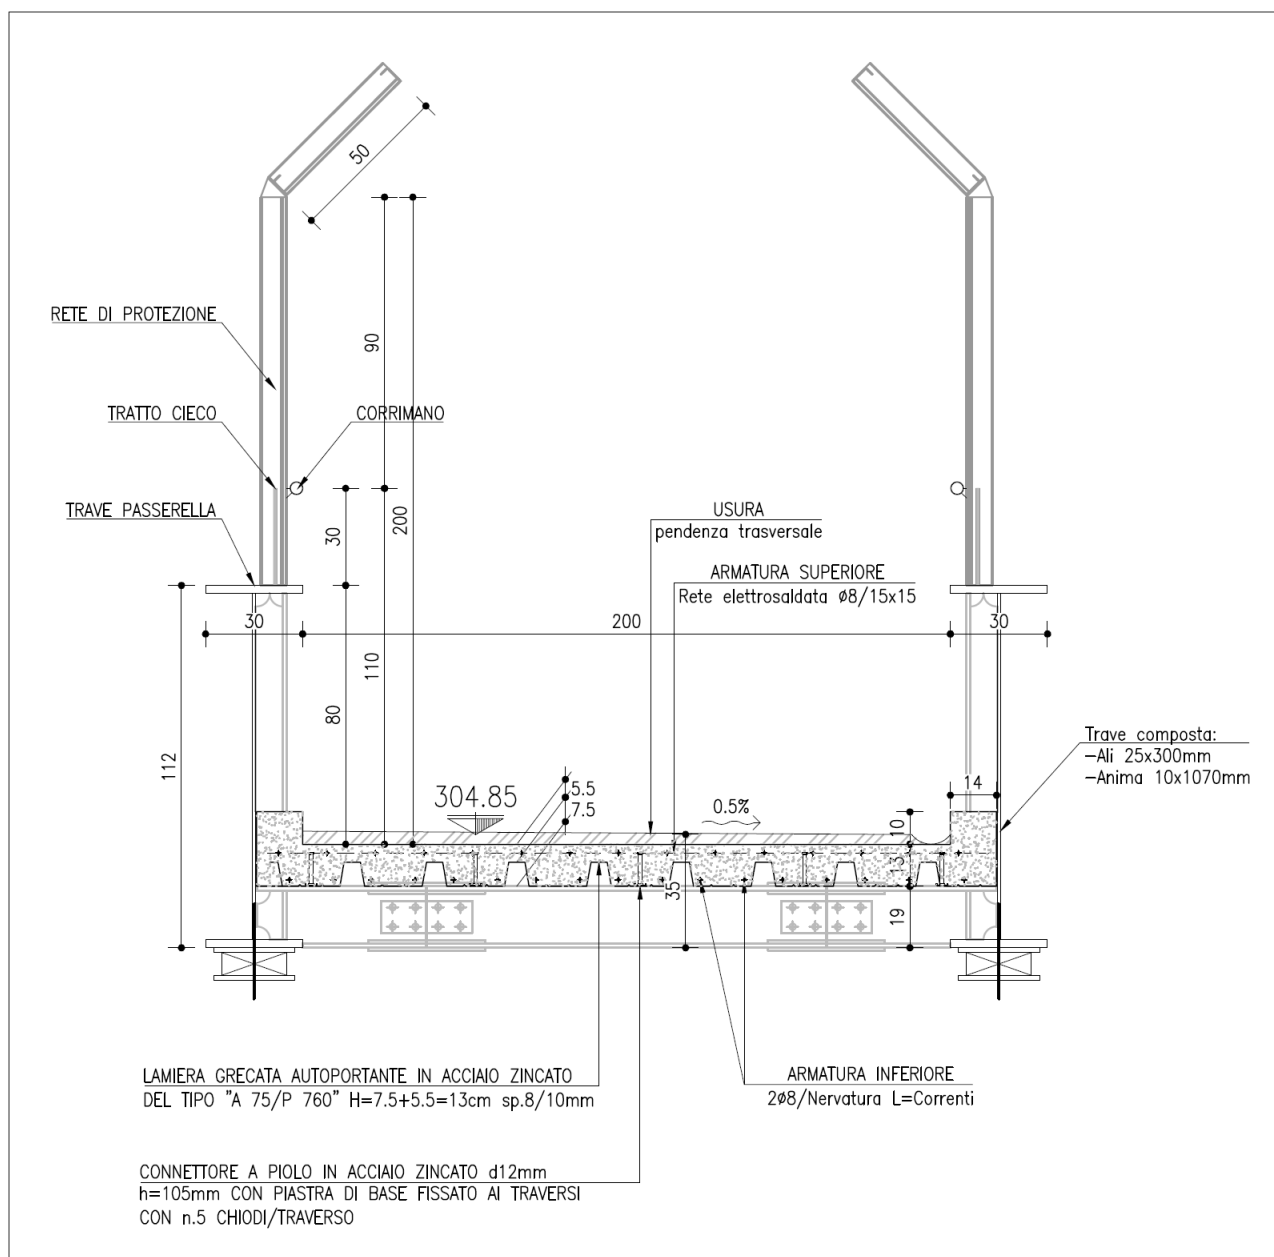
Sezione trasversale tipologica impalcato di scavalco
